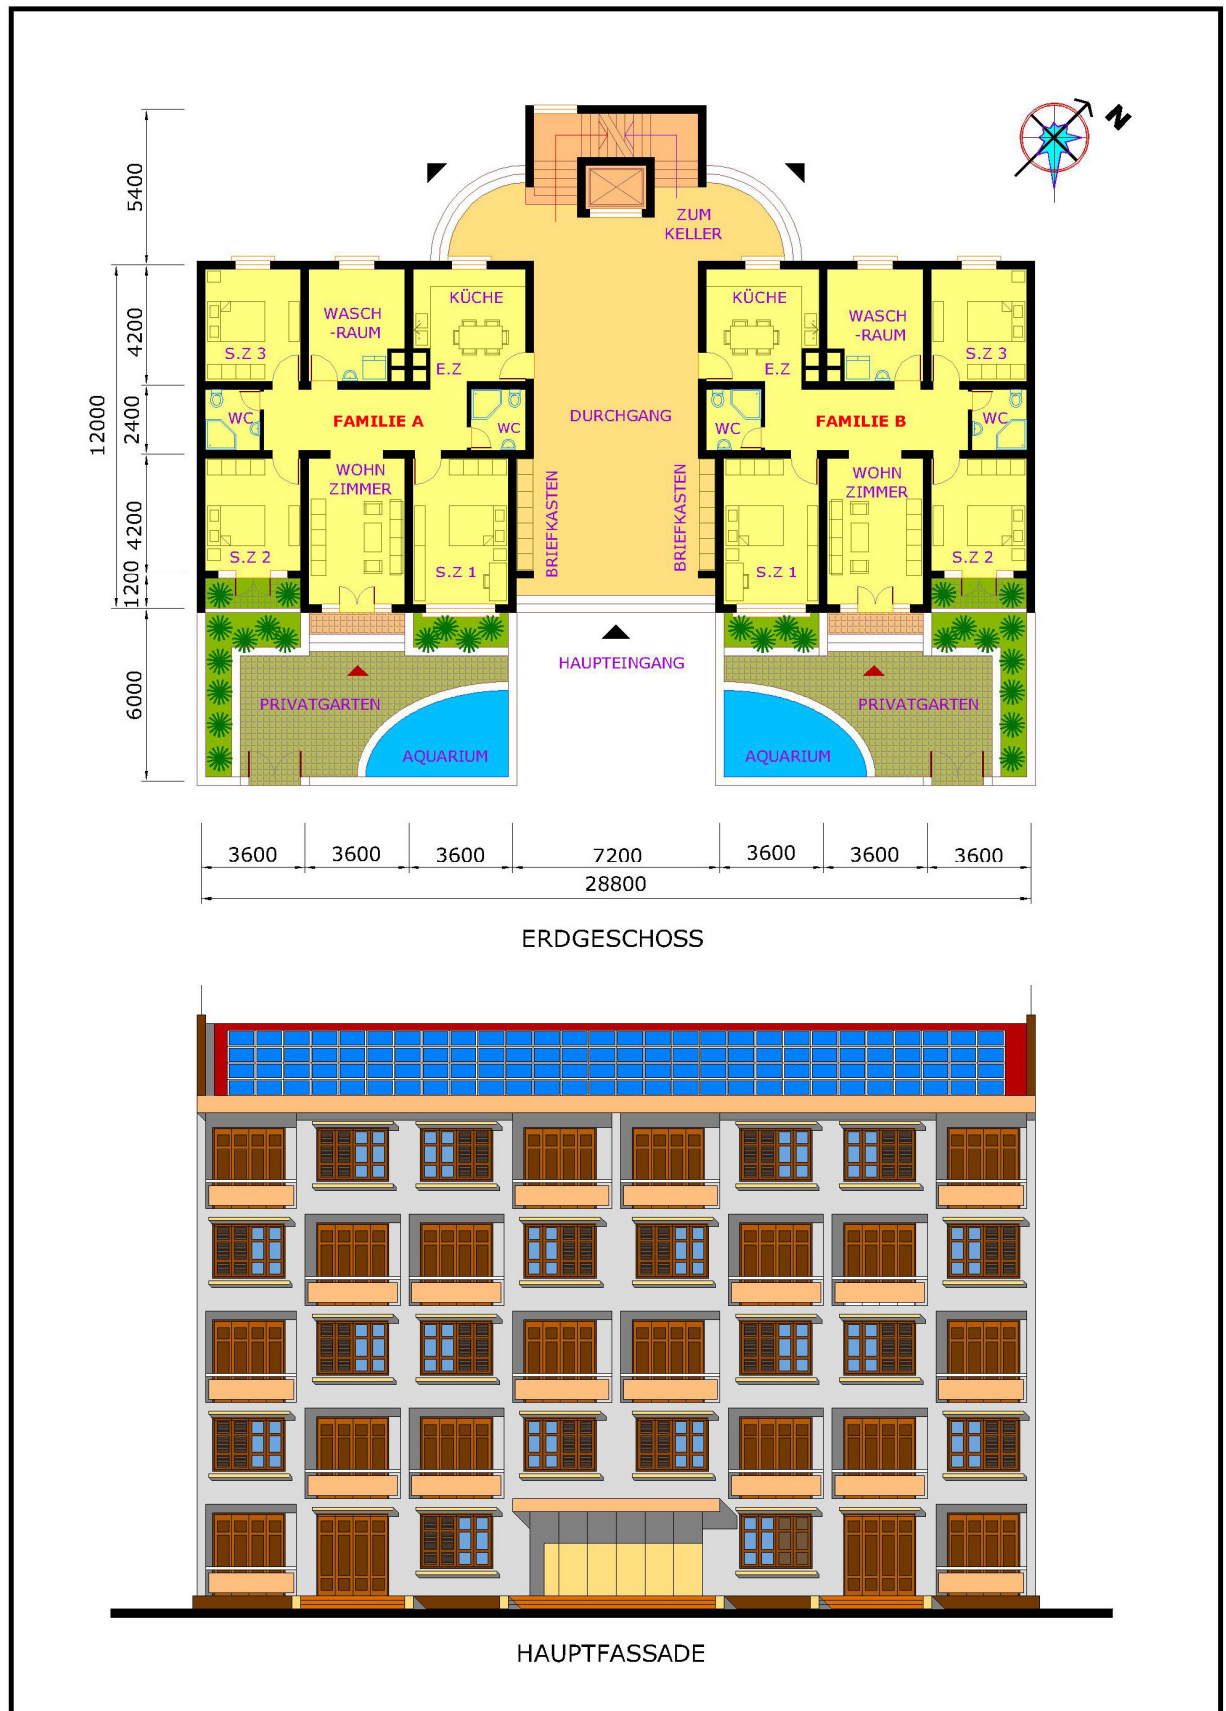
Konzeptentwicklung für Mehrfamilienhäuser: Grundriss und Hauptfassade
